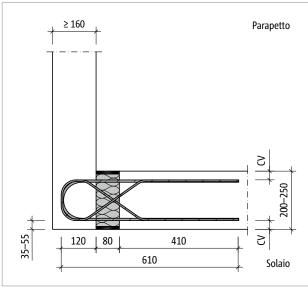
Schöck Isokorb® T tipo AP: sezione del prodotto
